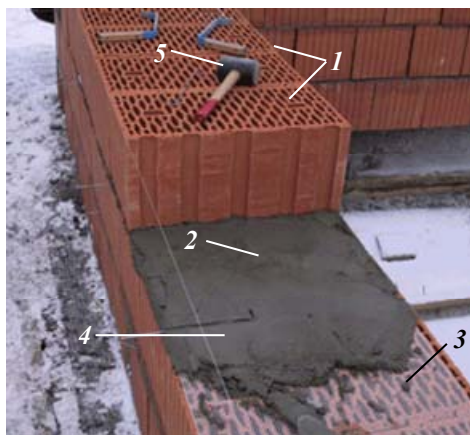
Фрагмент кладки наружной стены из блоков керамических поризованных пустотелых:
